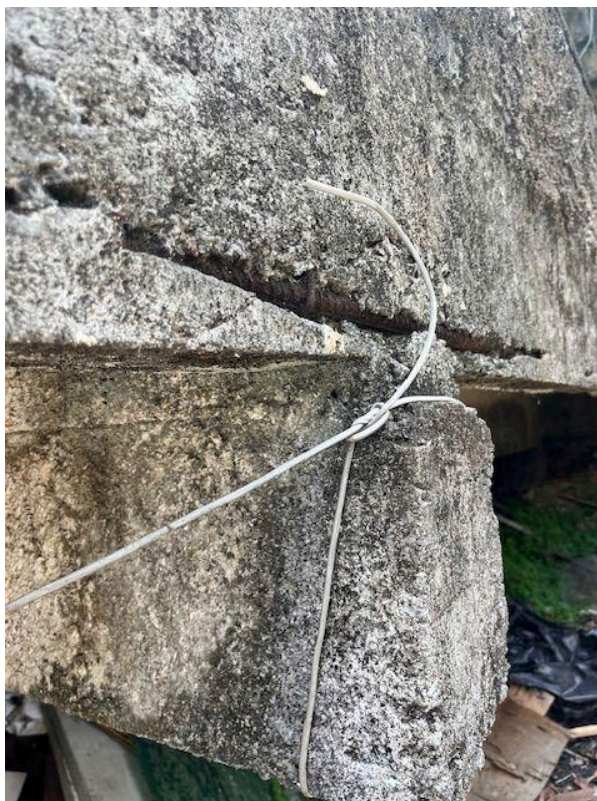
Marcação 3.6 a 3.8 - Corrosão de armadura nas vigas do subsolo (Vista superior).
